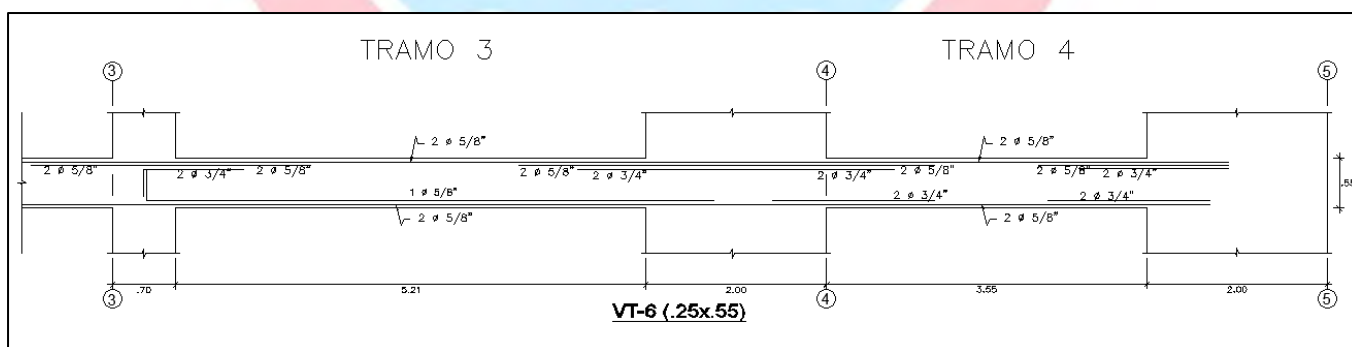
Arreglo del refuerzo longitudinal en los tramos "3" y "4" de la viga VT-6.
